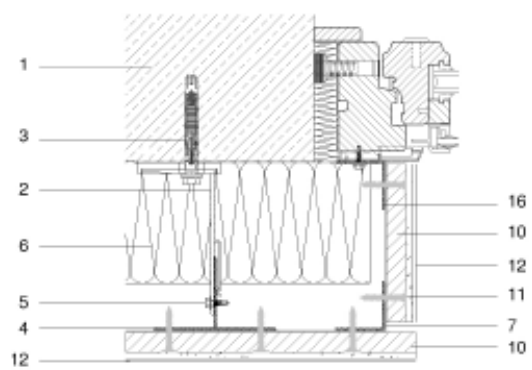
Detalhe construtivo de ligação entre a fachada e caixilharia corte horizontal [78].
